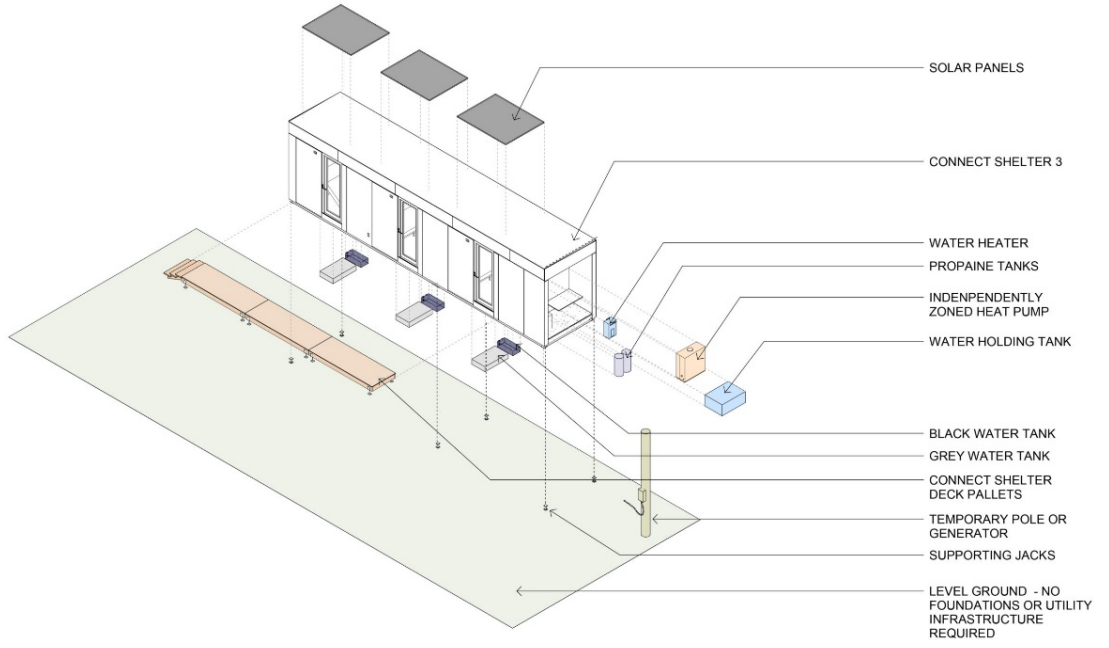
Connect Shelters örneği plan tipleri (Connect Shelters, b.t.)
